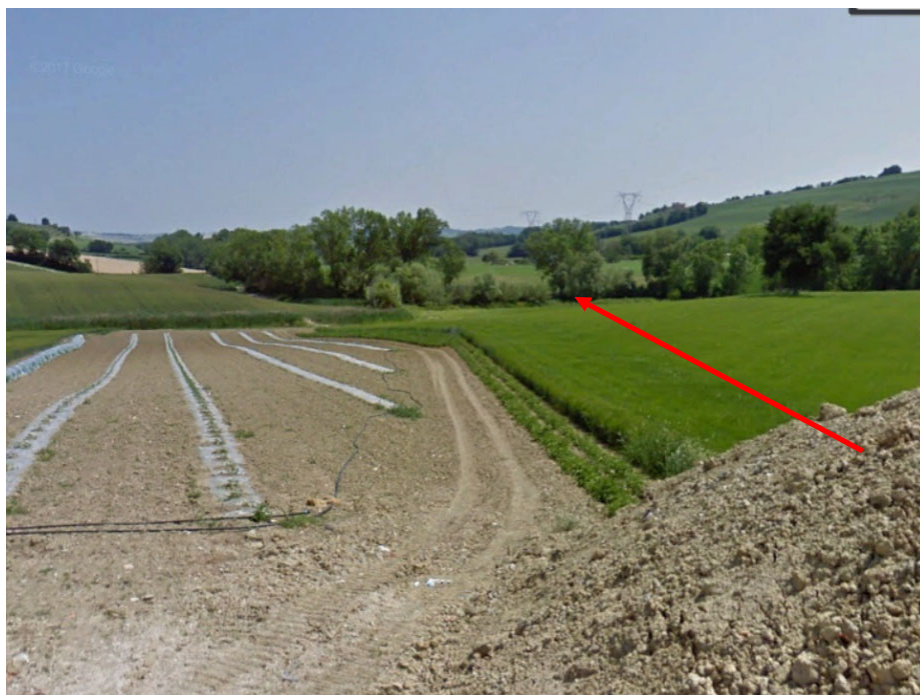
Filare attraversato dalla linea in progetto al km 116+238
